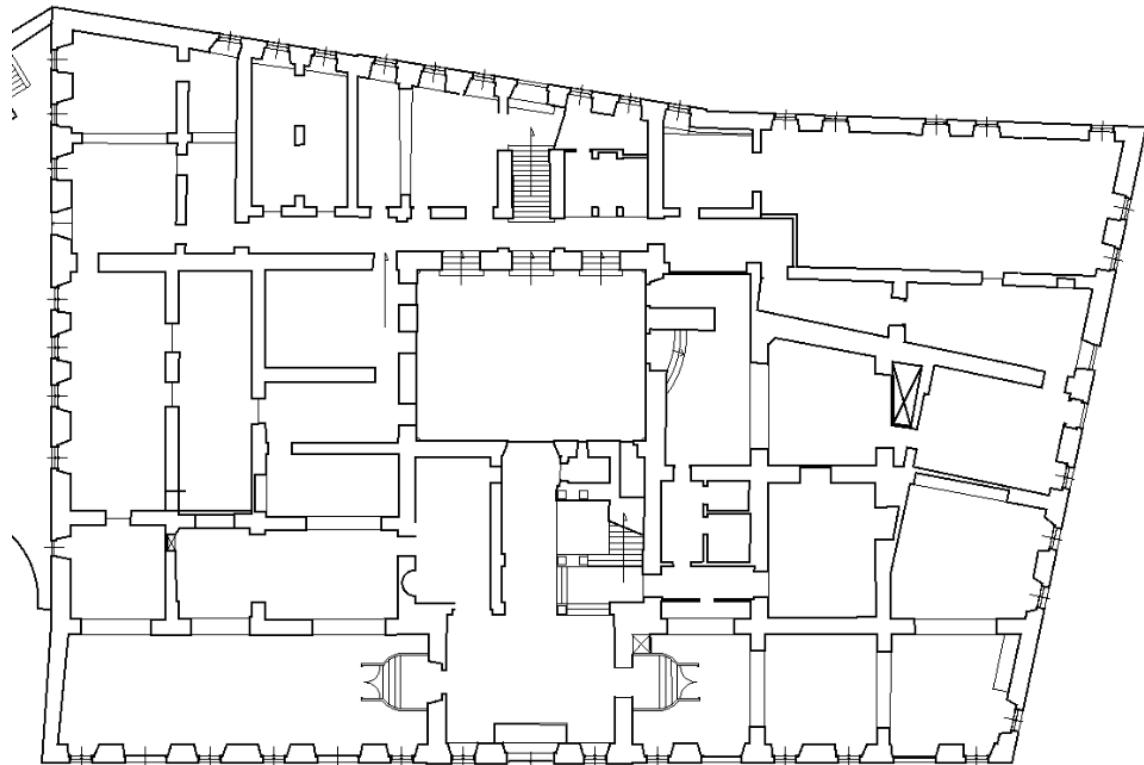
Planimetria fuori scala del piano terra dell'edificio
